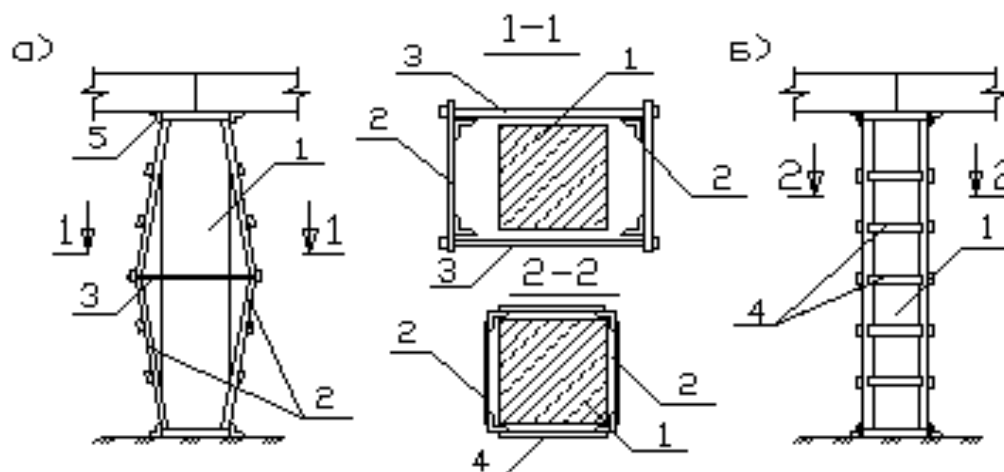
Підсилення колони металевою обоймою: а) – в період монтажу; б) – проєктне положення; 1 – колона; 2 – розпірки із кутиків та планок; 3 – натяжні монтажні болти; 4 – з'єднувальні планки; 5 – упорні елементи
